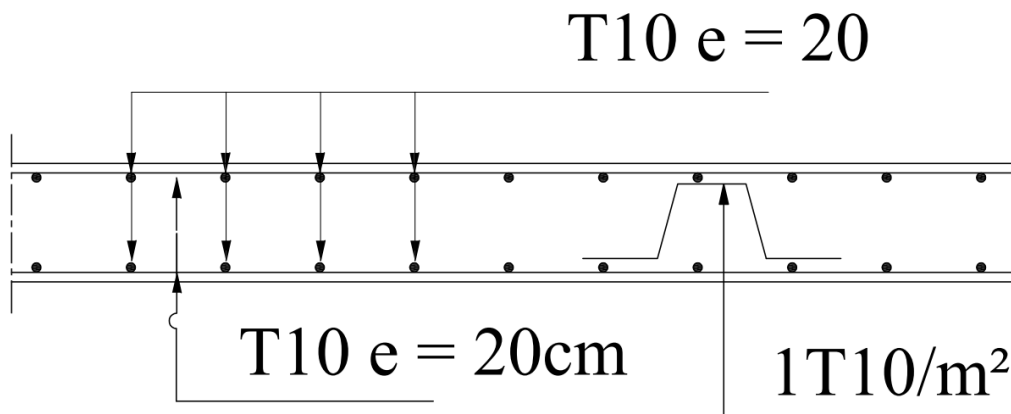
Schéma de ferrailage de la dalle machine d'ascenseur.
